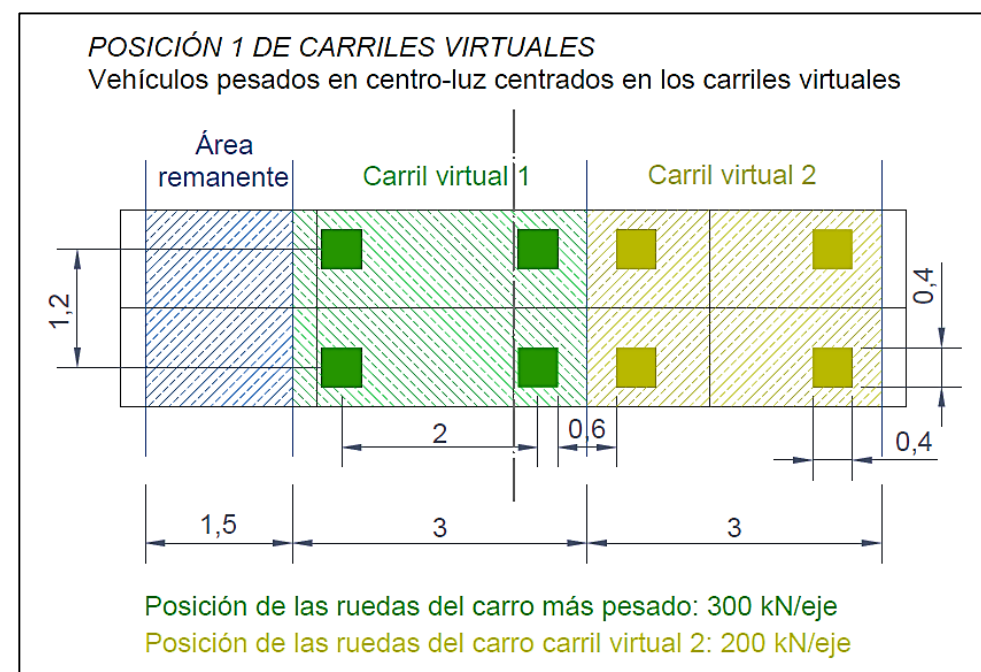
Caso 1 de sobrecargas de uso. Elaboración propia con AutoCAD
